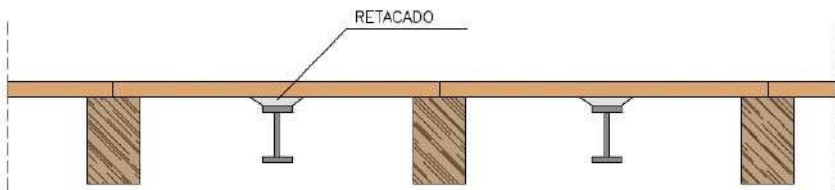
Refuerzo perfil metálico intermedio. Fuente propia
